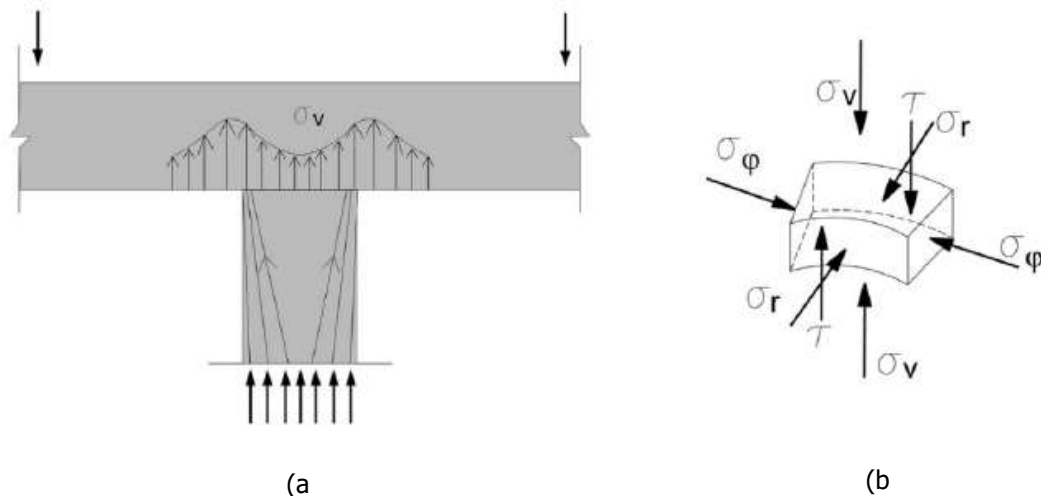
Sección conexión losa - columna (a) y detalle del estado tensional de la zona (b)
